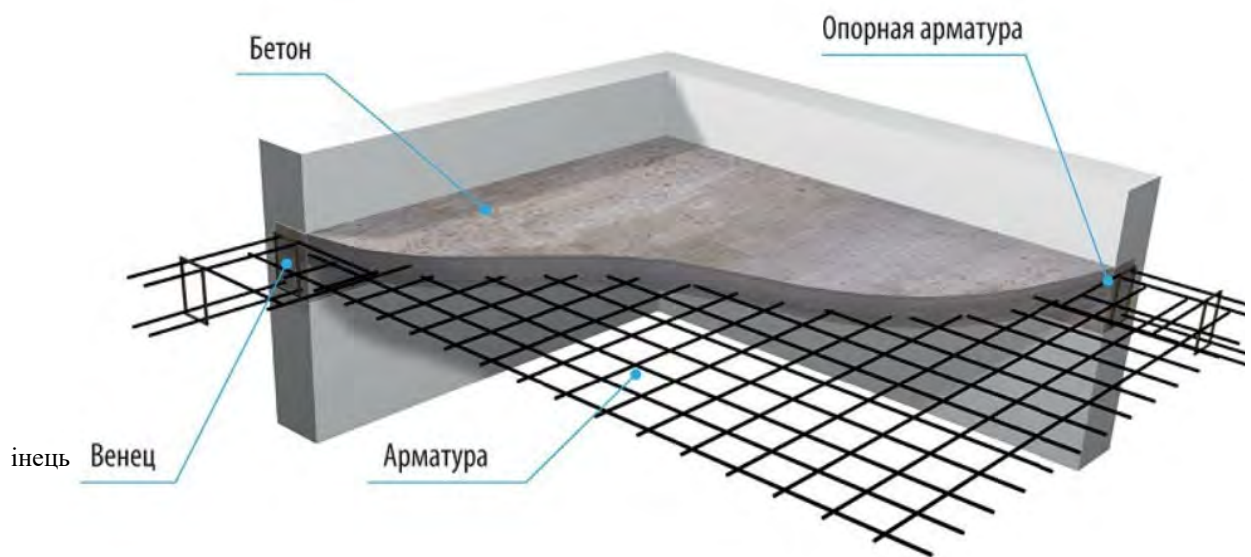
Схема монолітного залізобетонного перекриття [63]
